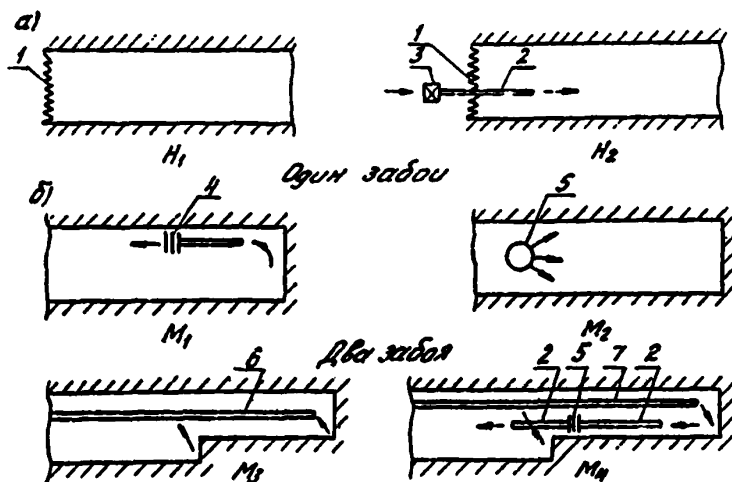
Схемы теплосвязи и размещения местных отопительных-вентиляционных установок:
